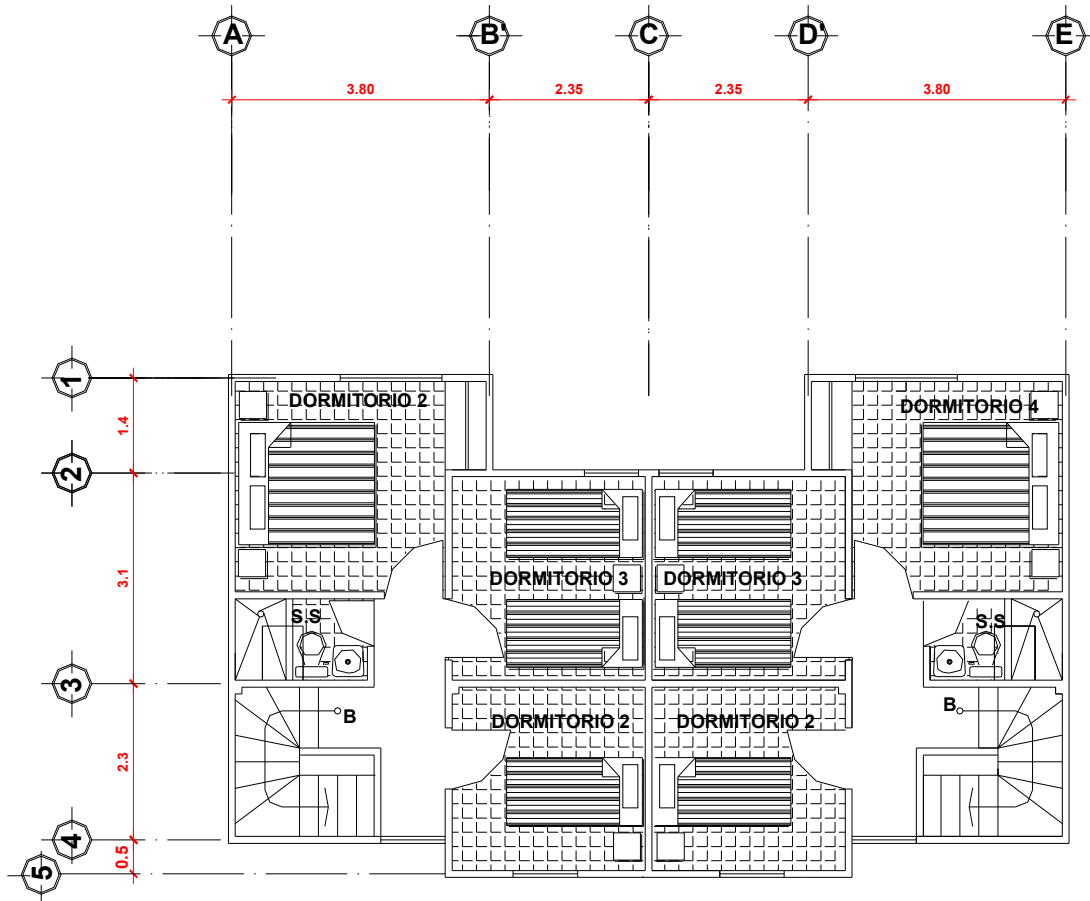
Plano de distribución del primer nivel, casa tipo dúplex
